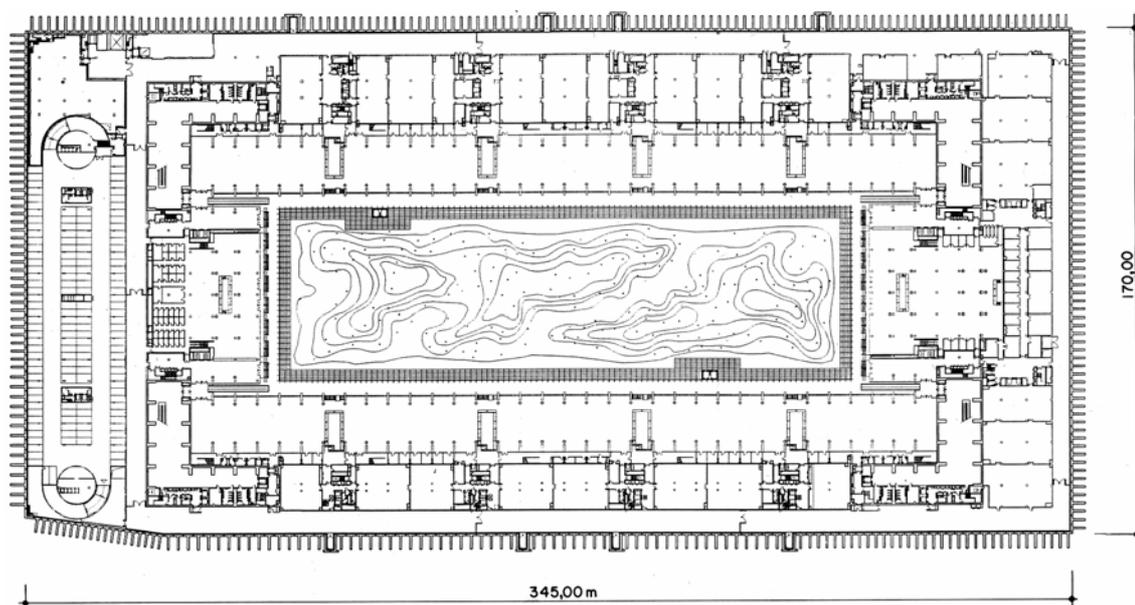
План здания на отметке 20,5 м от подошвы фундамента, где расположены внутренний сад, читальные залы и залы для научной работы
